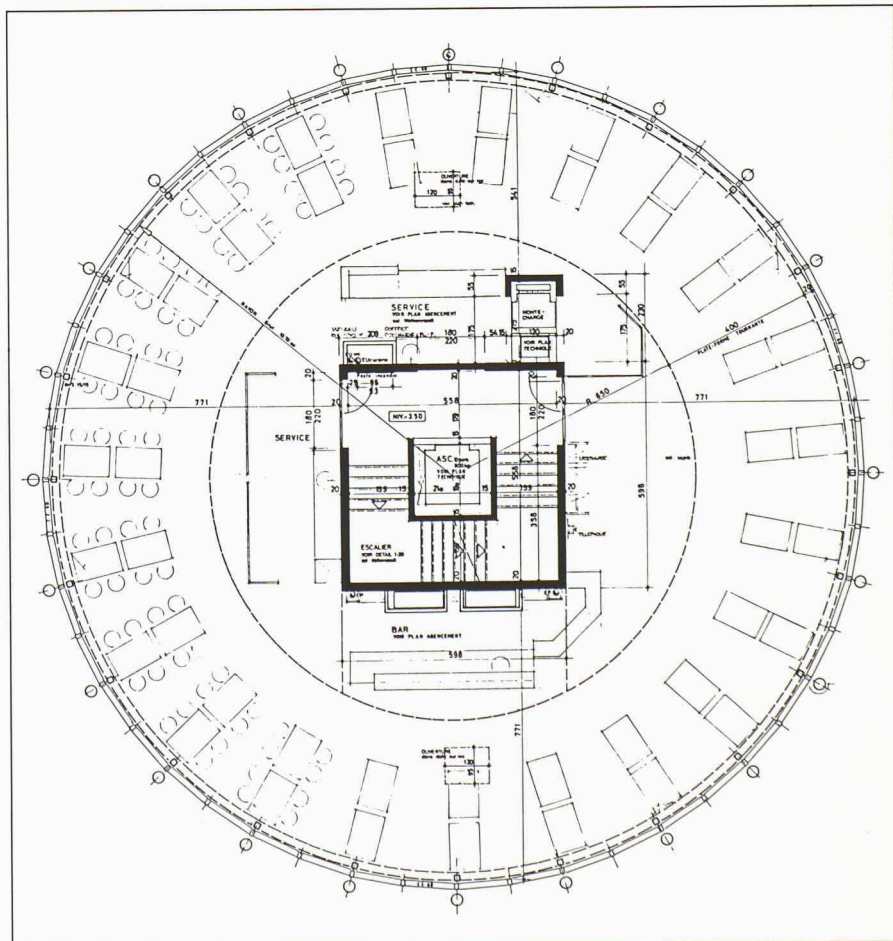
Plan du 1^{er} étage avec le restaurant.
